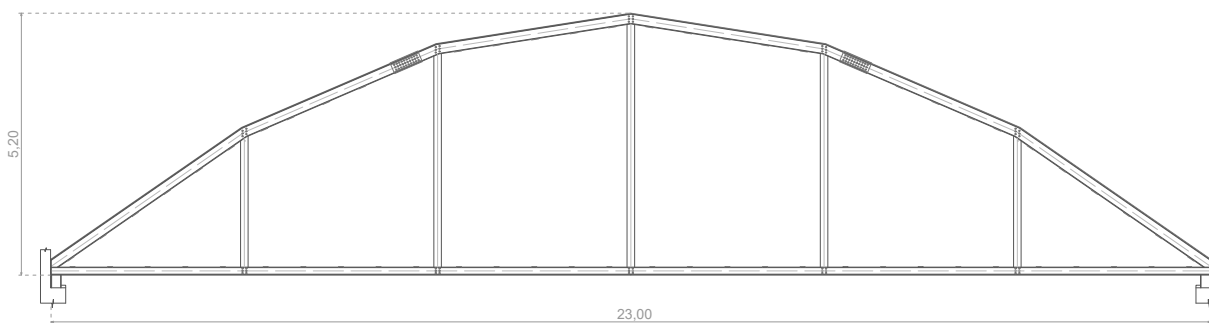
Alzado cercha TABSA. E: 1/150.
